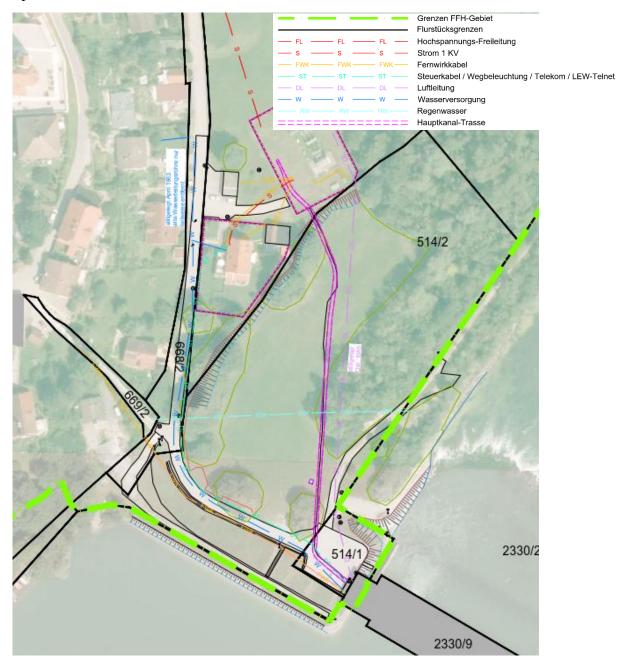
Lageplan Projektgebiet mit Sparteneintragung
